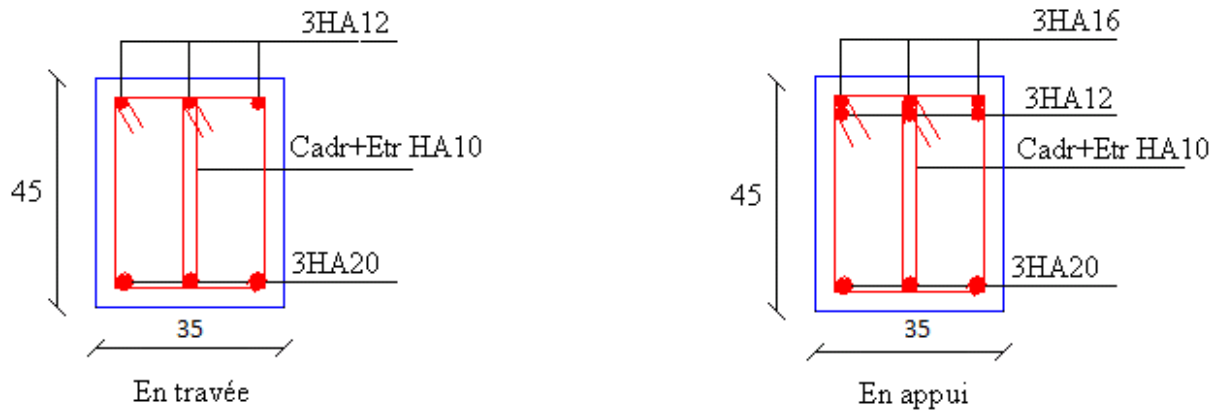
Schéma du ferrailage des poutres principales d'étage terrasse
